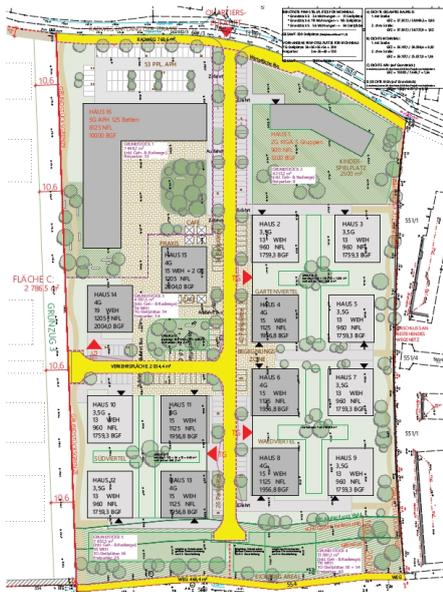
Quartiersplan mit Grundstücksteilung „Am Eichbergwald – Enns“, F2 ARCHITEKTEN ZT GmbH vom 05.05.2023
